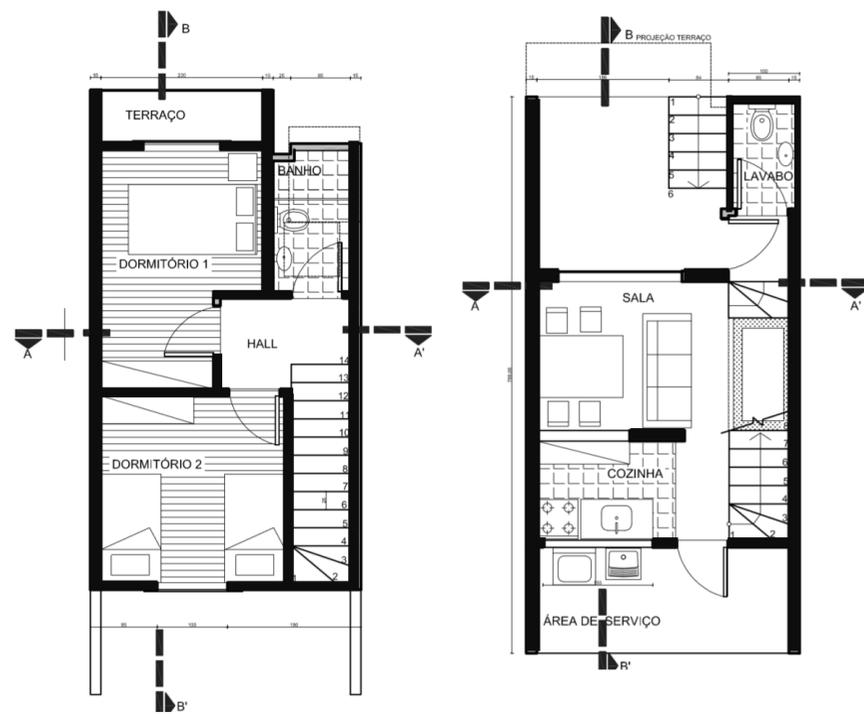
Plantas Baixas Segundo Pav. e Pav. Térreo
